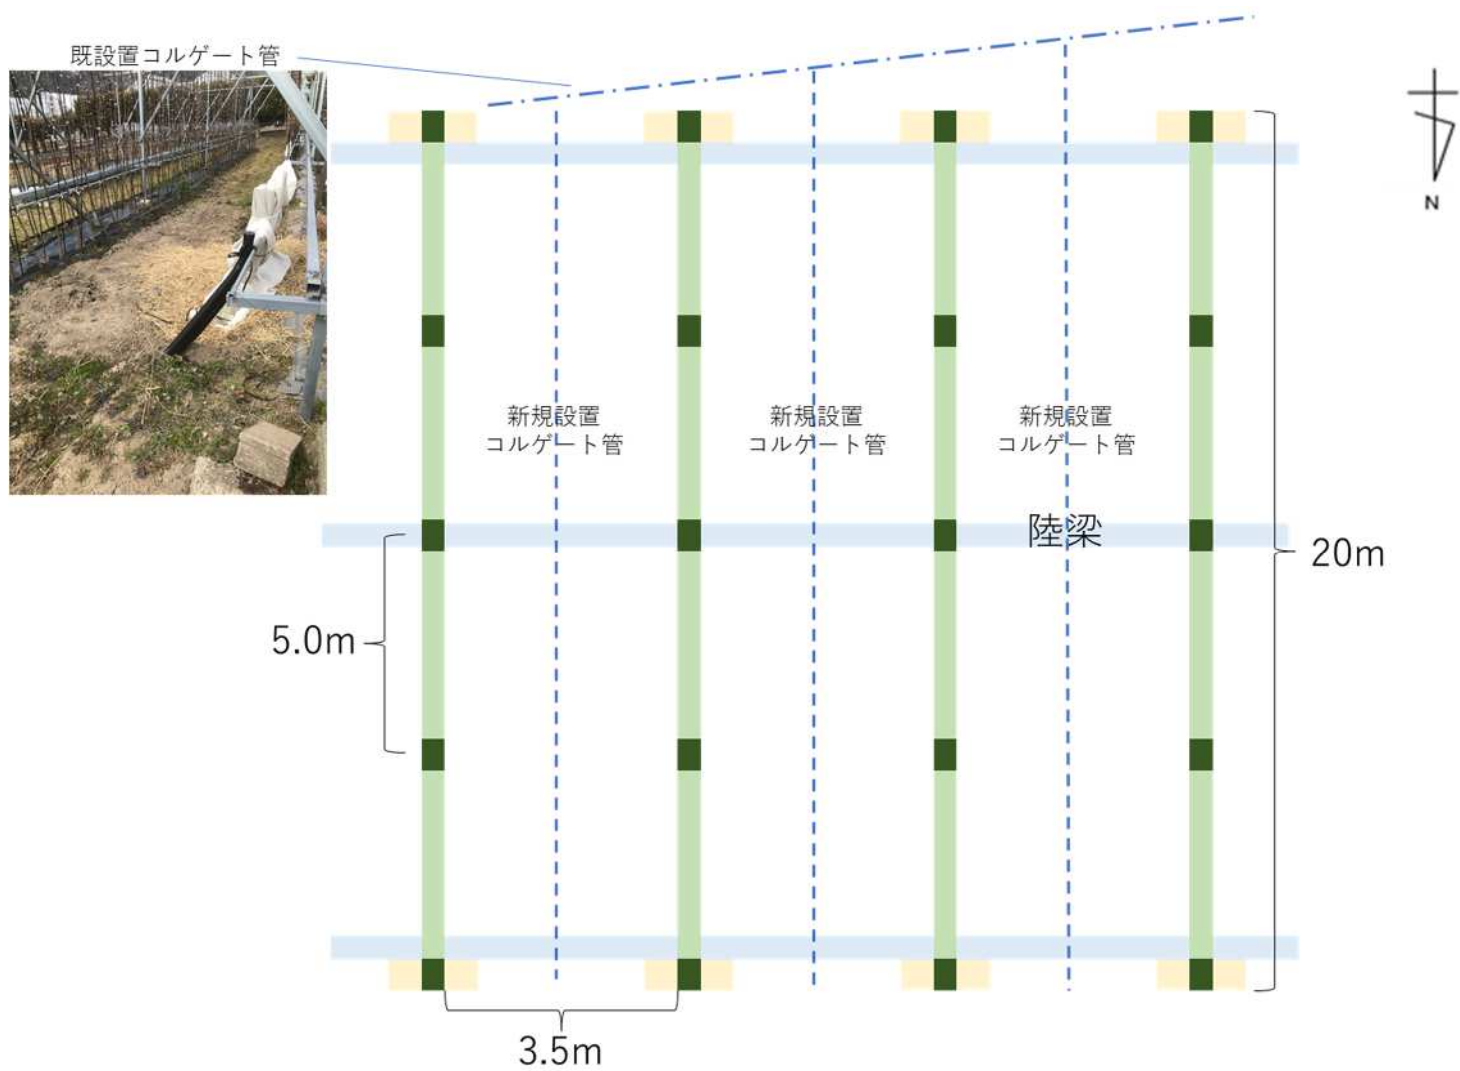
育苗施設の平面図及びかんがい設備（コルゲート管）設置位置
